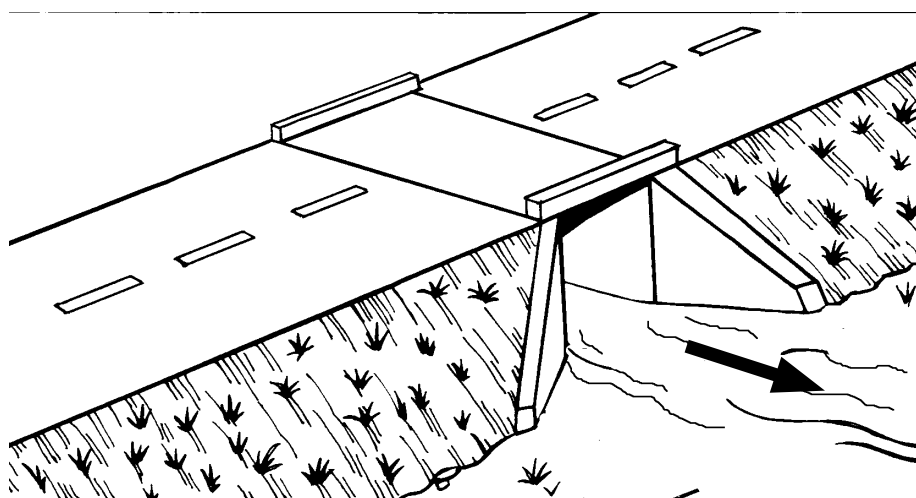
Protección a la entrada y salida de las alcantarillas.
